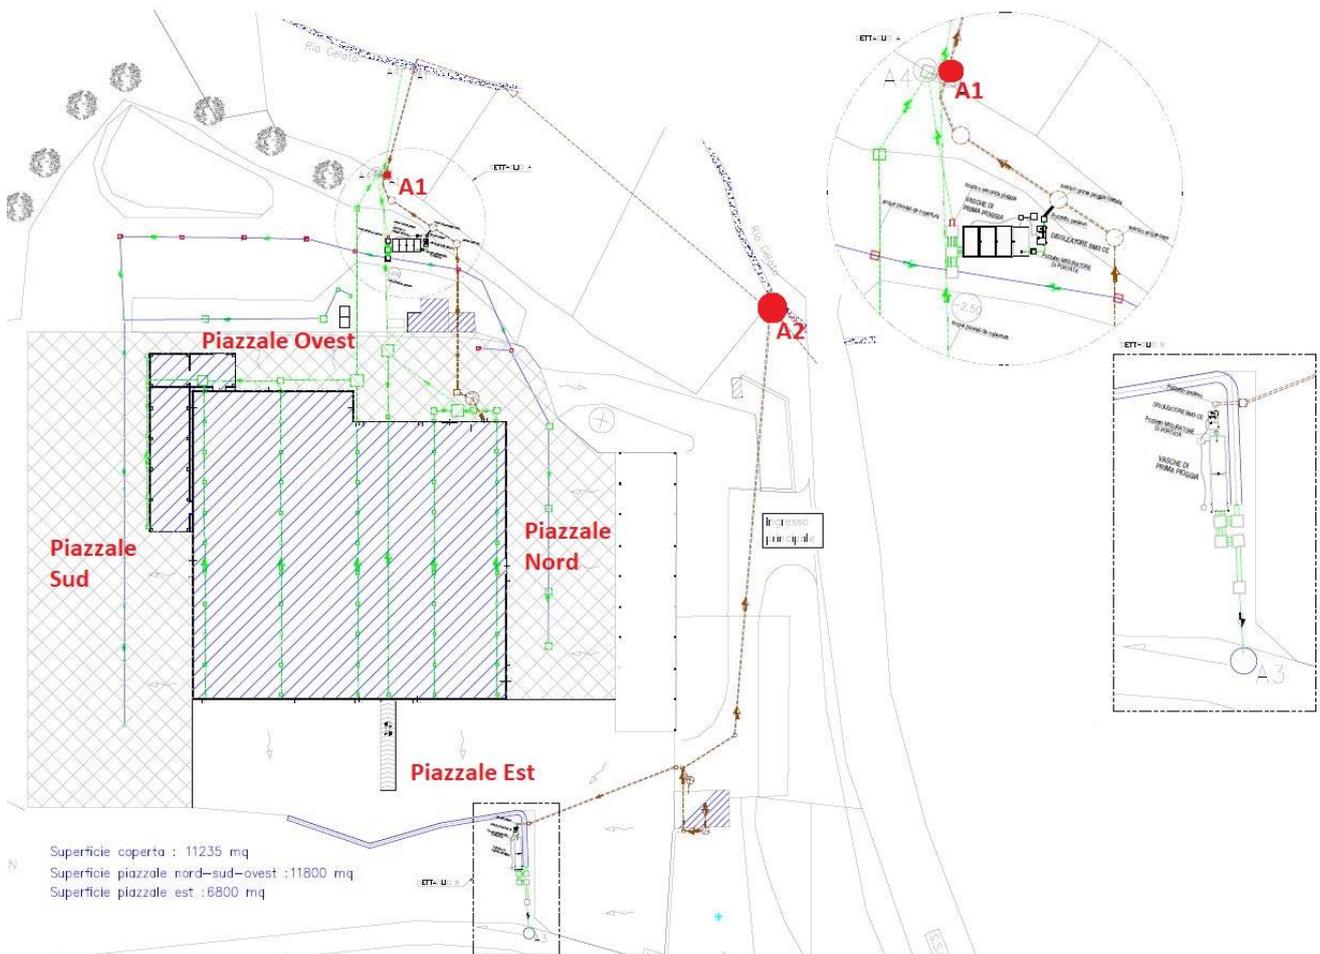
Layout con indicazione della rete di raccolta e scarico acque reflue
